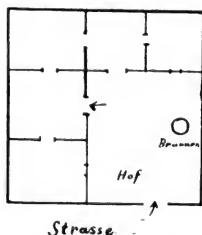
Schematischer Grundriss eines Hauses in Athen. (S. 182.)
